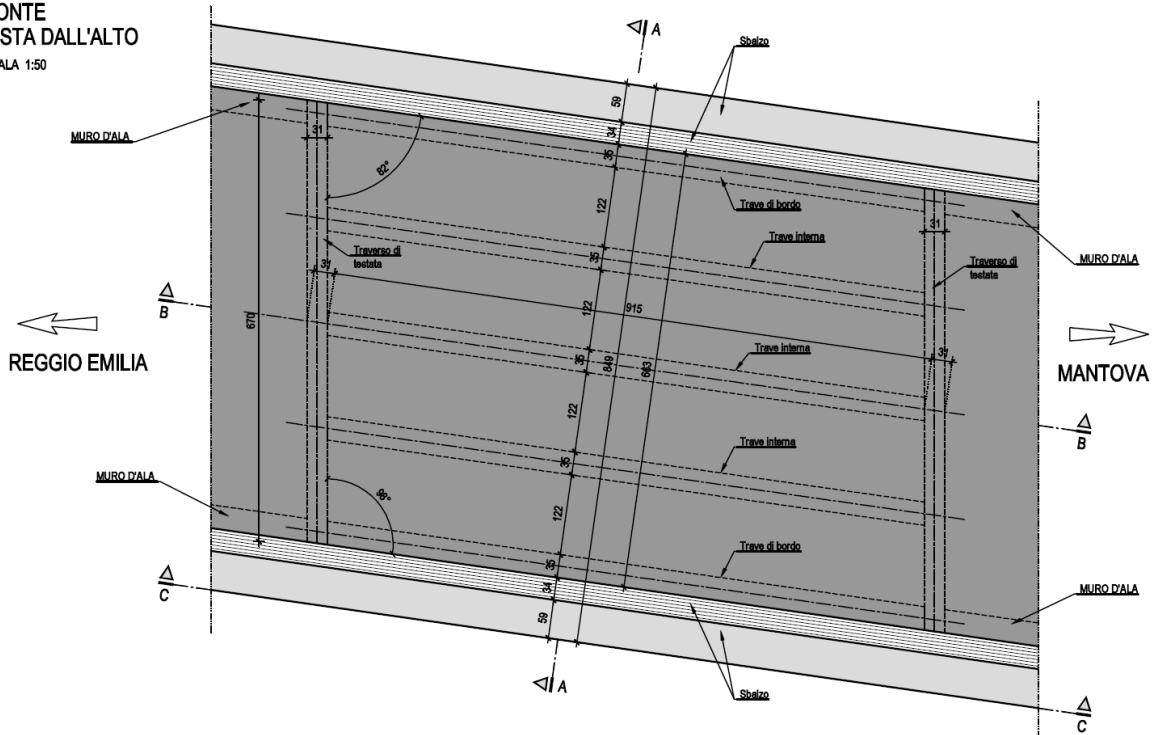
Rilievo geometrico dell'impalcato – Vista in pianta
